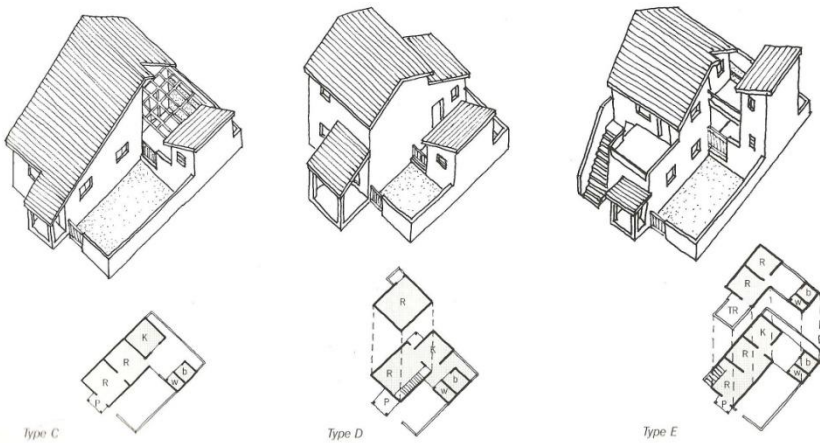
Tipologías C, D y E, axonometrías y plantas
